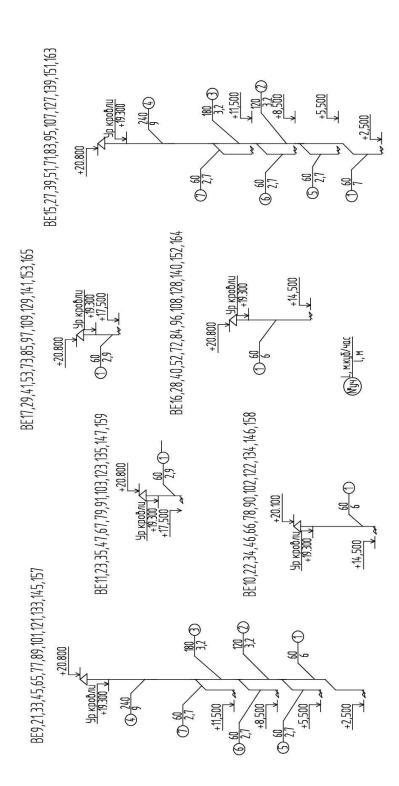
Расчетная схема канальной вентиляции кухонь
